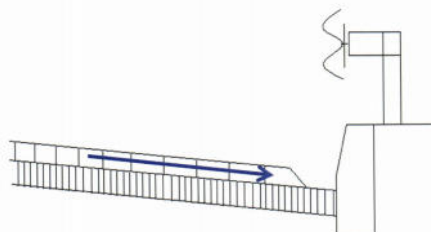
Открытый лоток, устроенный путем укладки верхнего слоя покрытия меньшей на 10см ширины
